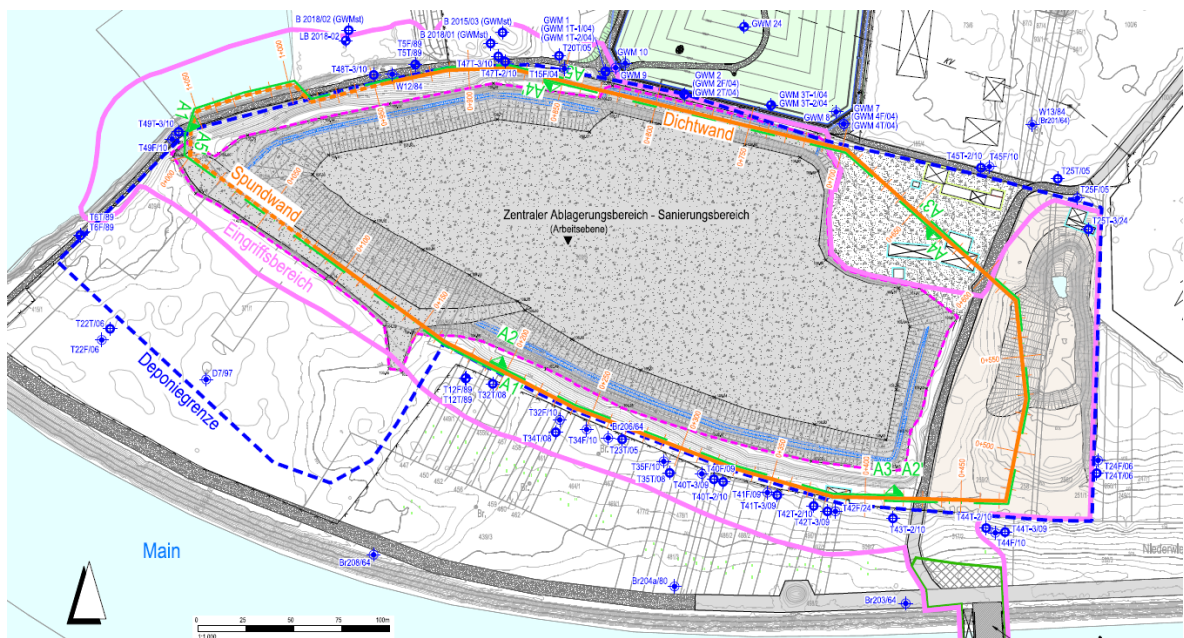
Lageplan der Altdeponie einschließlich Sicherungsbereich
